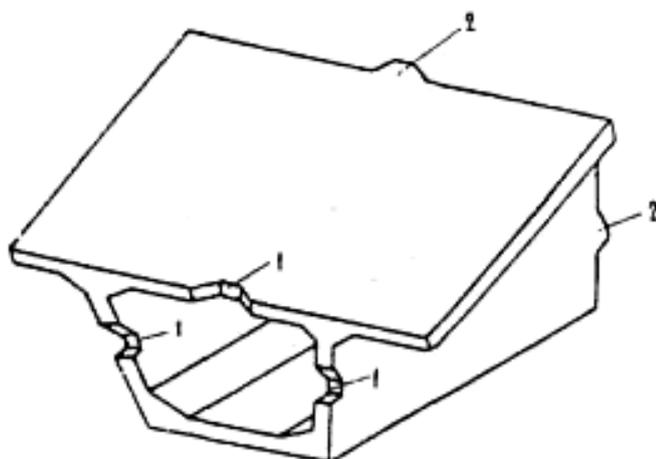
Общий вид блока с железобетонными фиксаторами: 1-гнездо; 2- шип [77]
